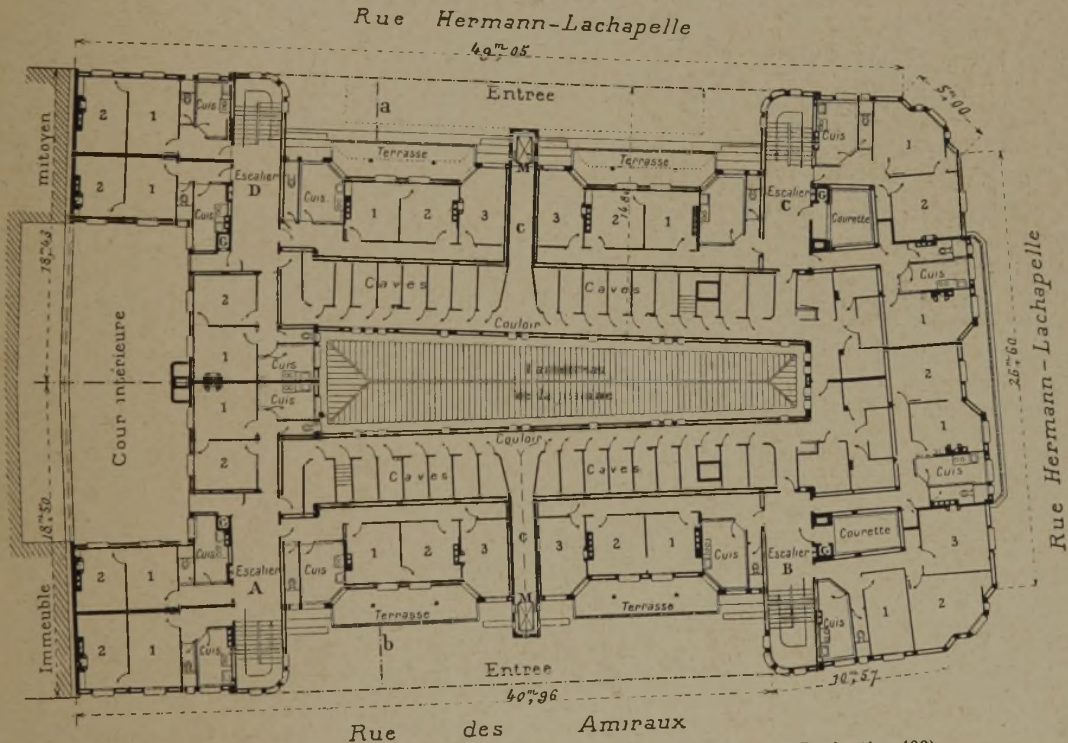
Grundriß des städt. Baublocks in der Rue des Amiraux, Paris (1 : 400).
